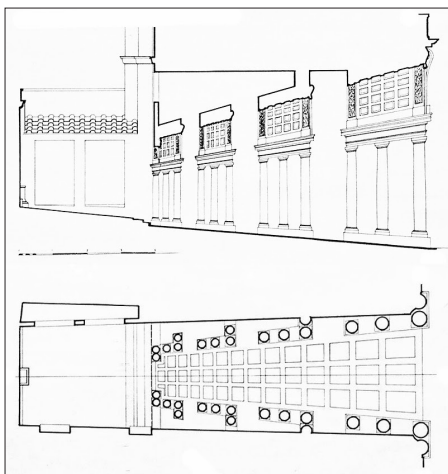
Planta e alçado de Palazzo Spada, Roma por Francesco Borromini, 1635
